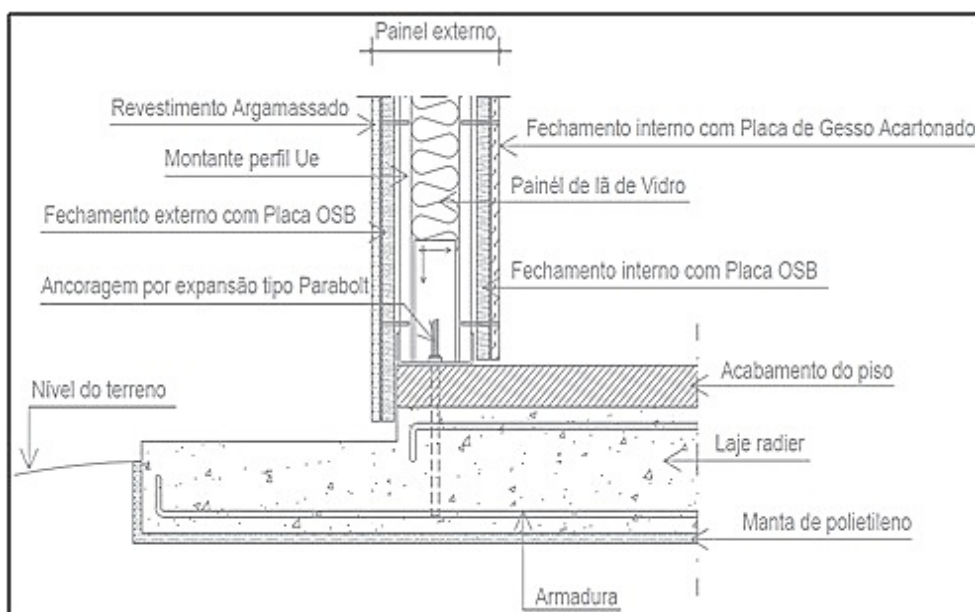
Detalhe esquemático de ancoragem de painel estrutural ao radier
